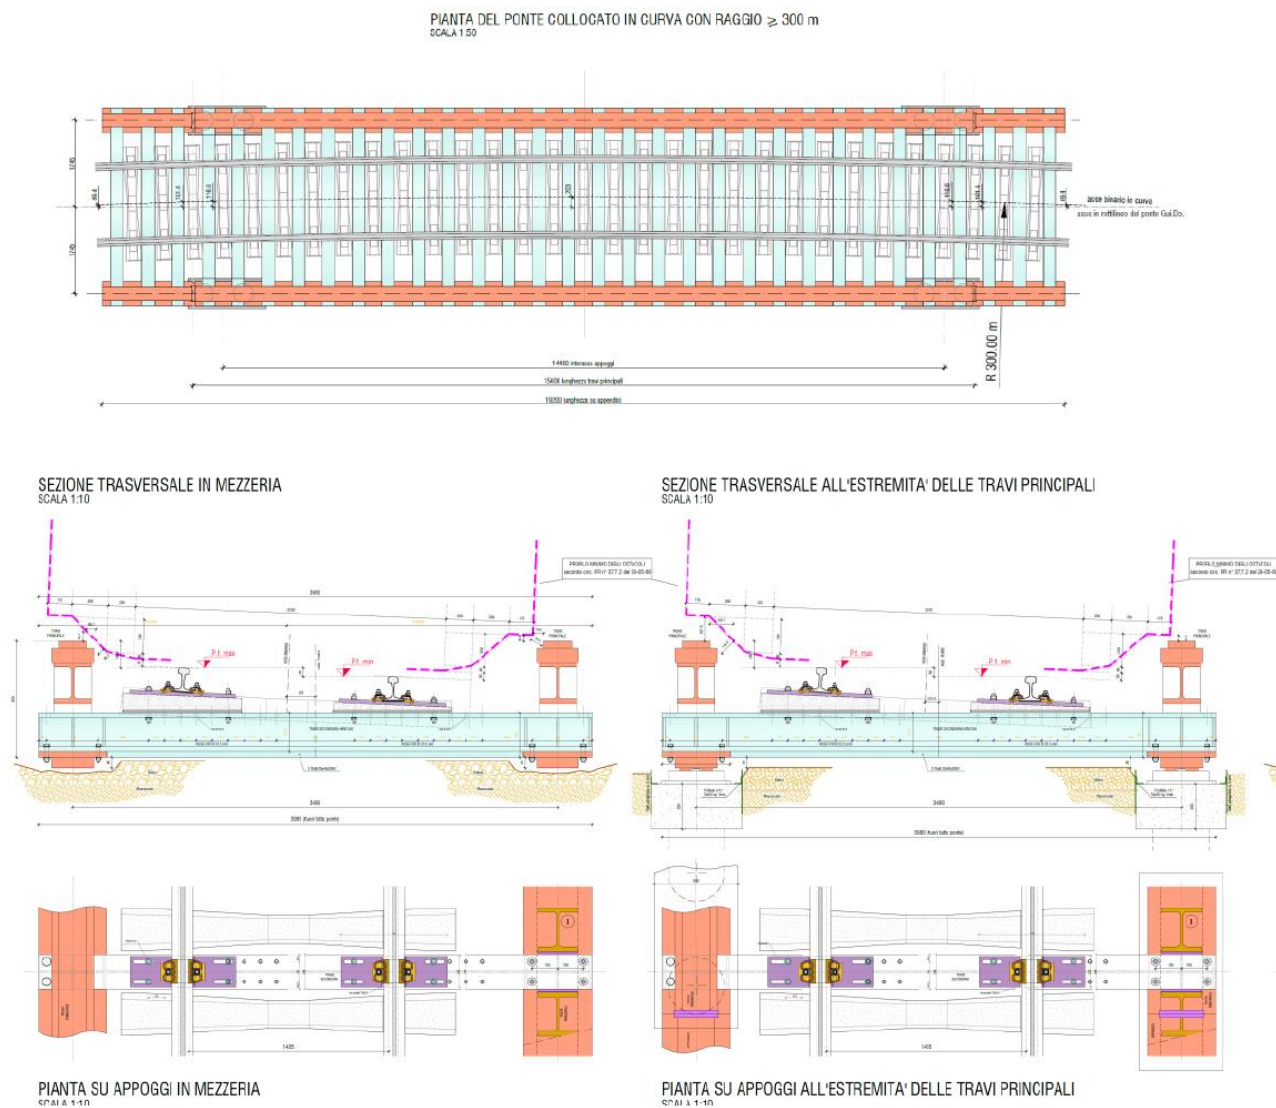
Sistema di sostegno provvisorio “Ponte GUI.DO” – pianta e sezioni (MdP P.II sez.2)
